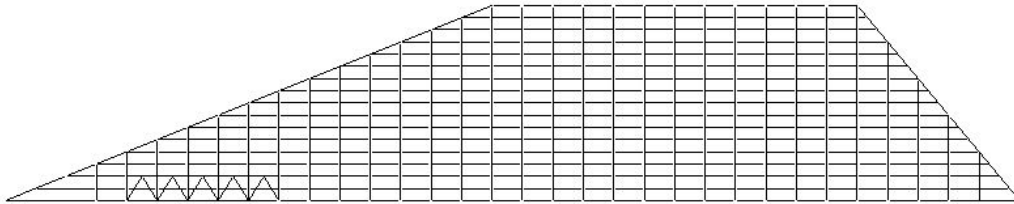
Pianta del progetto con gli arcarecci tra le travi reticolari.
